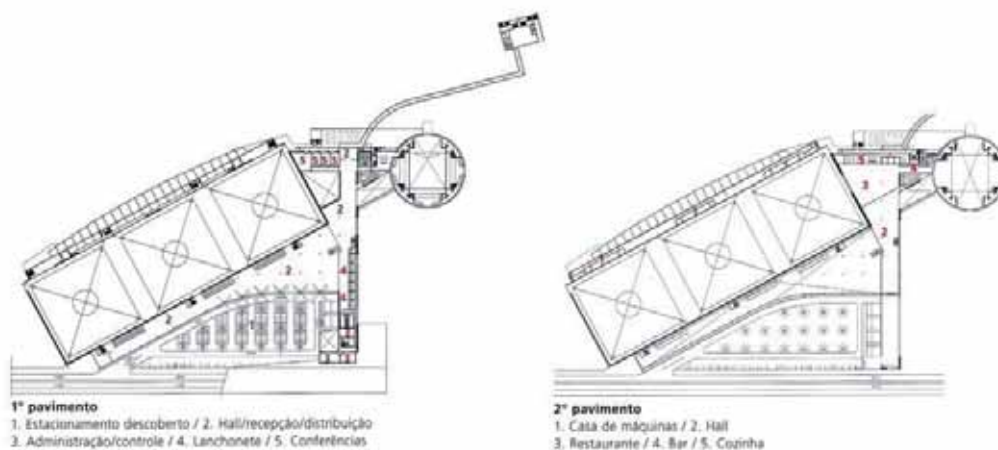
, à esquerda: EXPO MINAS - Planta pavimento 1. Fonte: Revista FINESTRA 47 pag71
